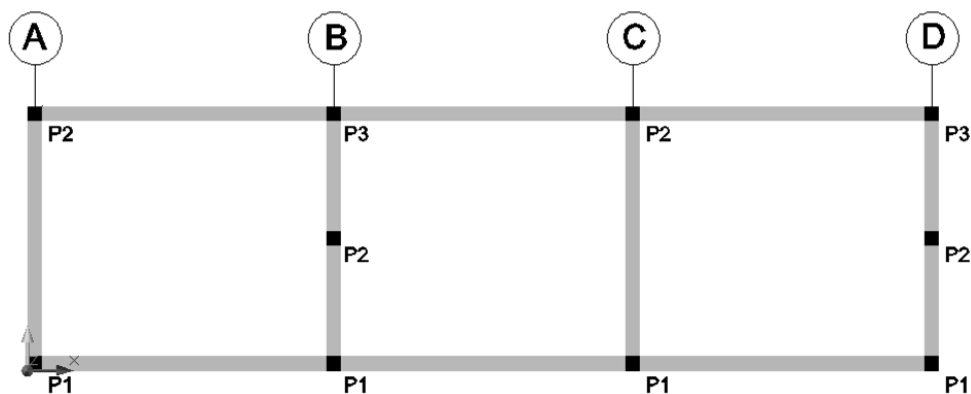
38 – Disposição dos pilares para comparação (vista em planta).
